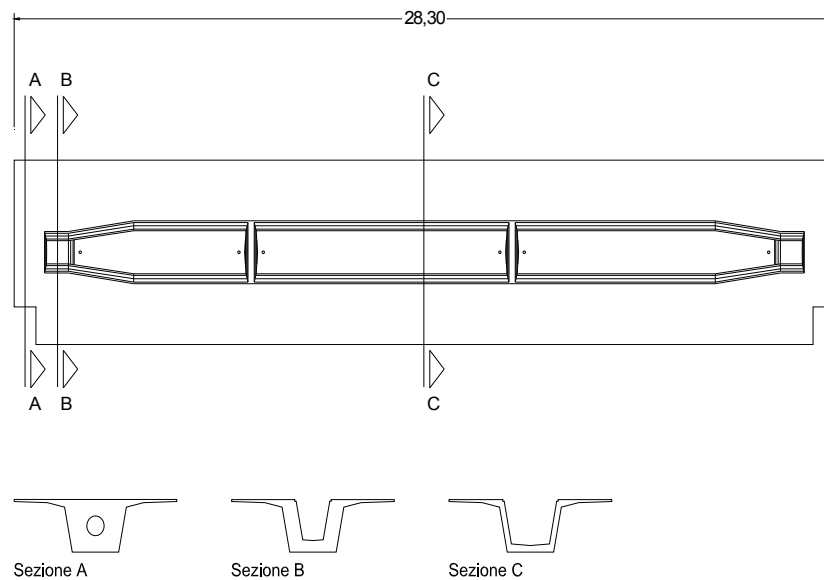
Sezione longitudinale e sezioni trasversali della trave.
